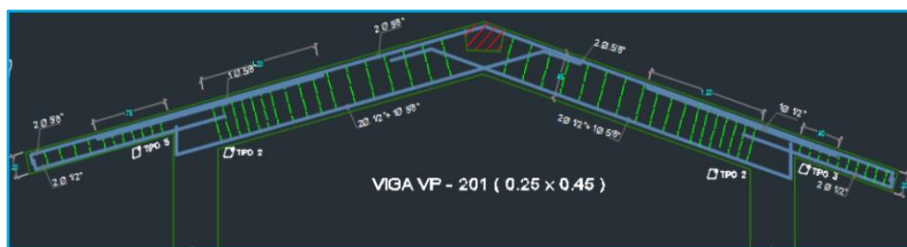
Detalle de las dimensiones de la viga VP-201 y el acero de refuerzo
